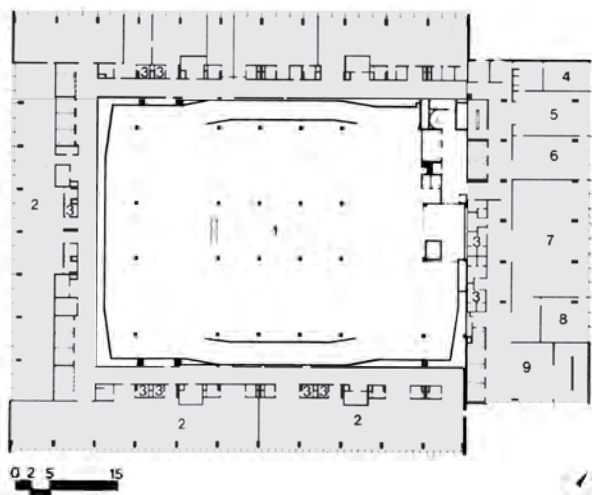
Lucio Costa: Edifício-Sede do Jockey Clube Brasileiro, Rio de Janeiro, 1956. Planta do 3º pavimento com a indicação (sombreado) da parte construída em concreto armado. [XAVIER, 1991]: 102
